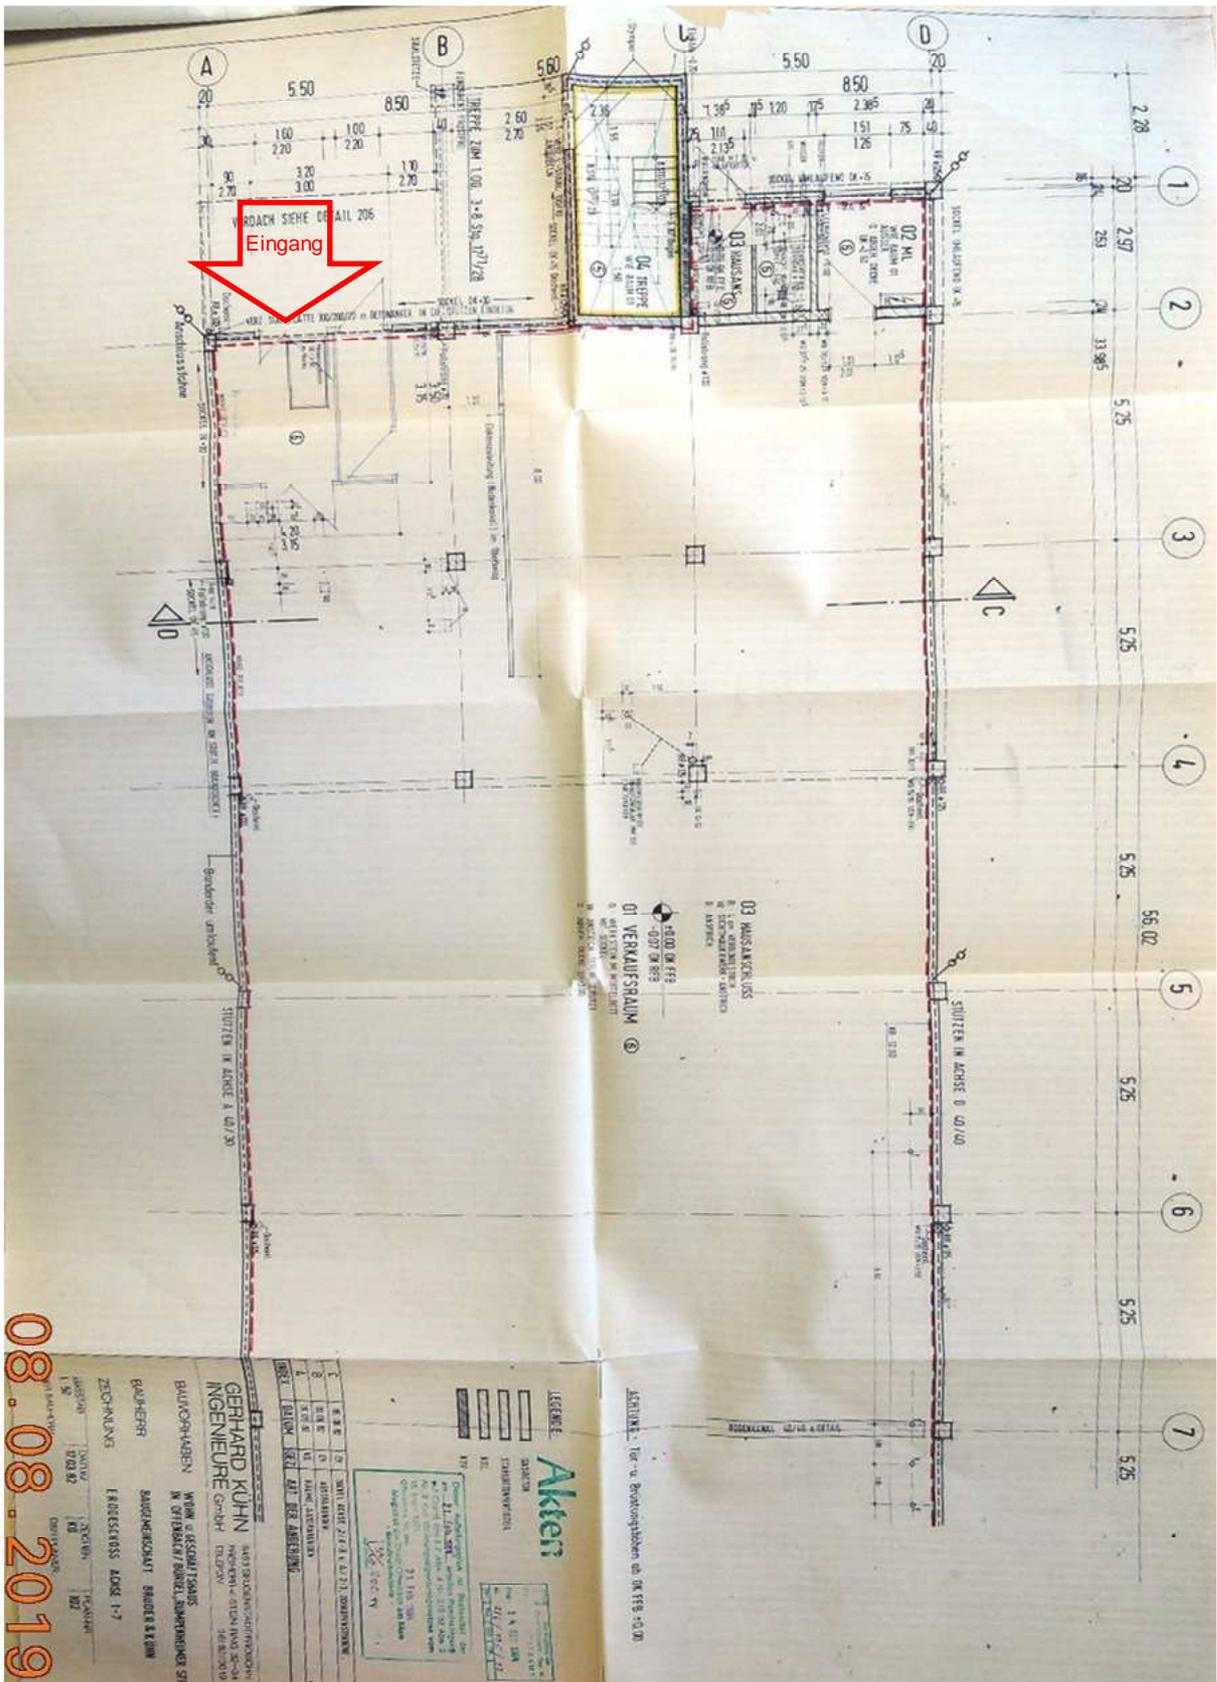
Grundrissplan Erdgeschoss straßenseitiger Bereich (nicht maßstabsgetreu, aus Bauakte)
